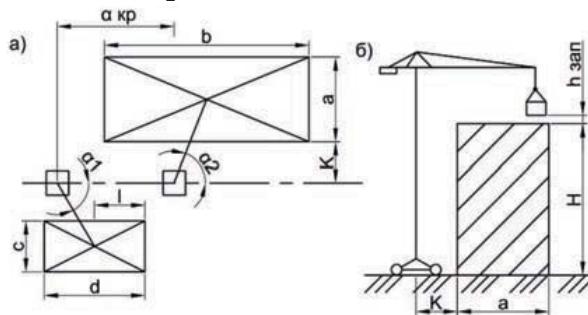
Розрахункова схема баштового крана. а – план, б - фасад
